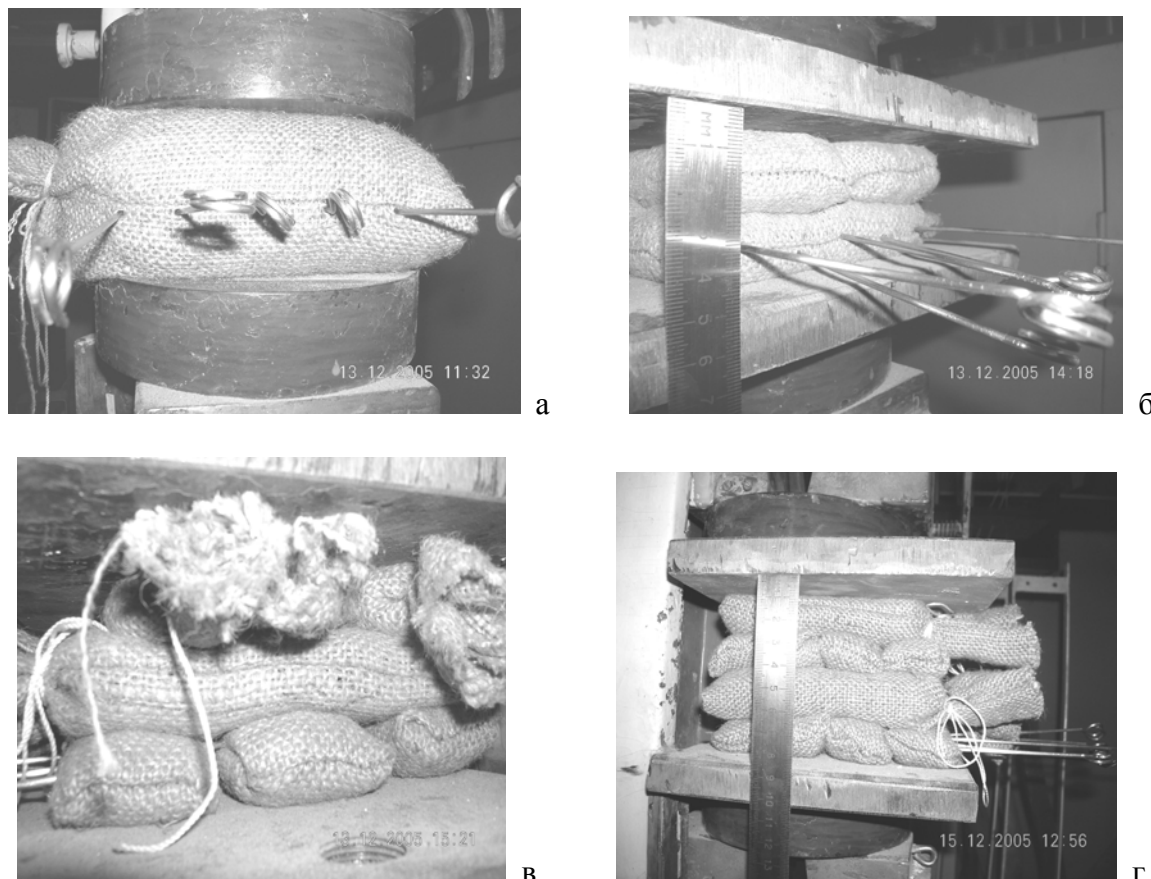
Схемы укладки породных стоек: а – схема № 1; б – схема № 2; в – схема №3, г – схема №4
